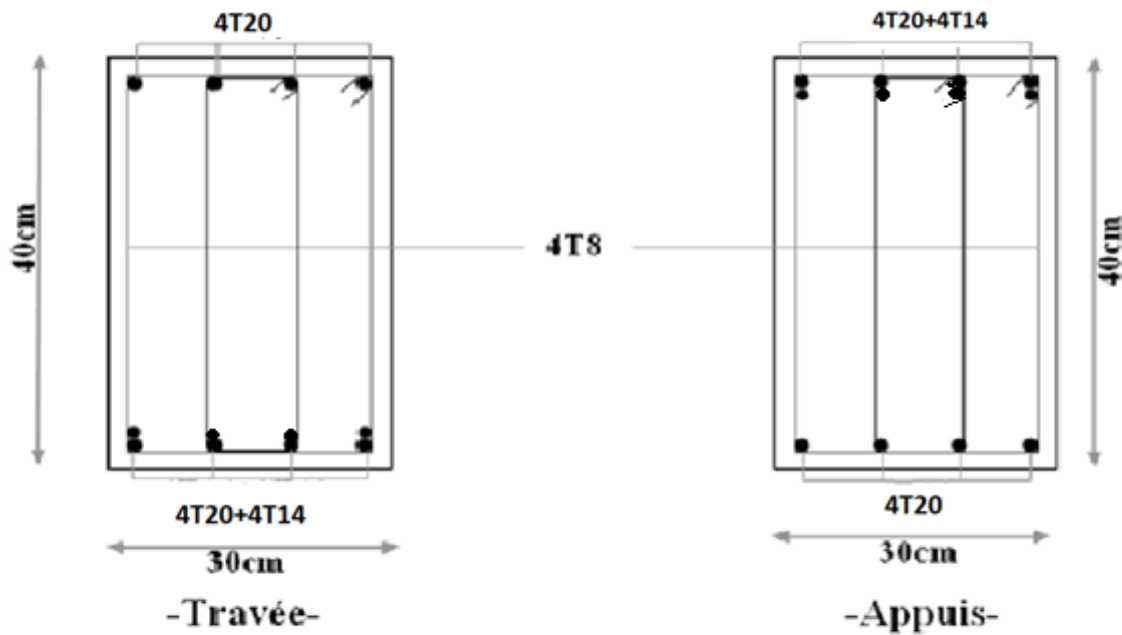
Schéma de ferrailage des poutres secondaires d'étage commerce.
